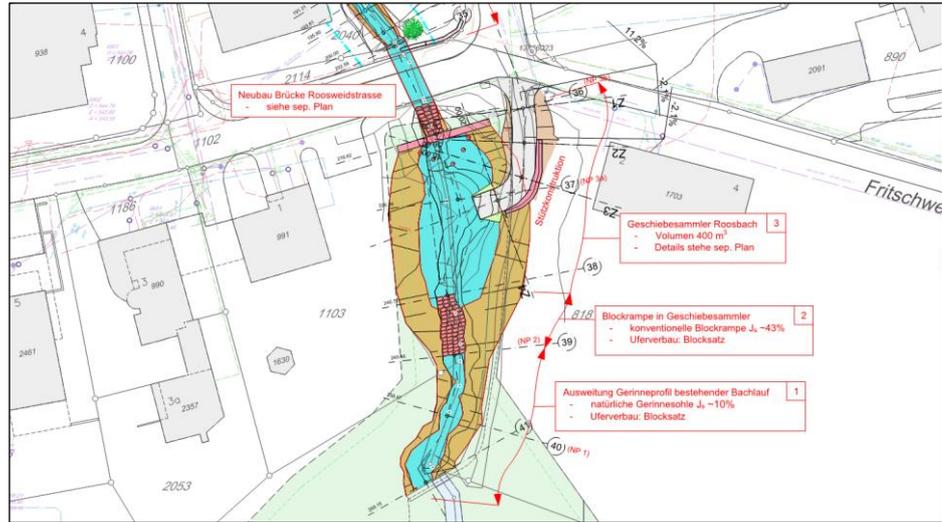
Geplanter Geschiebesammler am Roosbach, Quelle: Hochwasserschutz Krebsbach,, CES Bauingenieur AG und Geoterra AG
